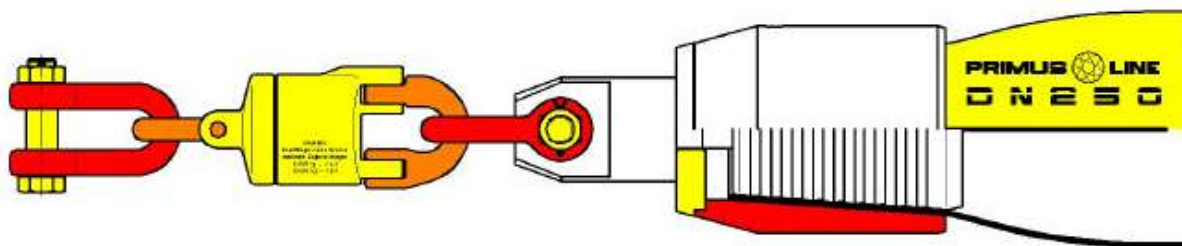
Блок в сборе: рукав – втягивающая головка – вертлюжный крюк – скоба
